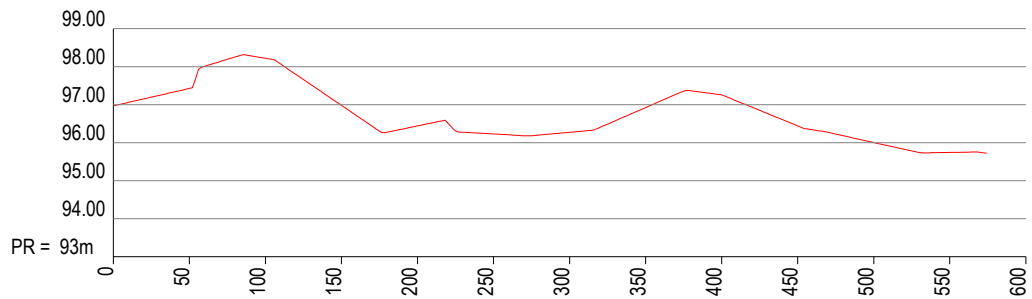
Perfiles longitudinales - VERTEDERO N°2
